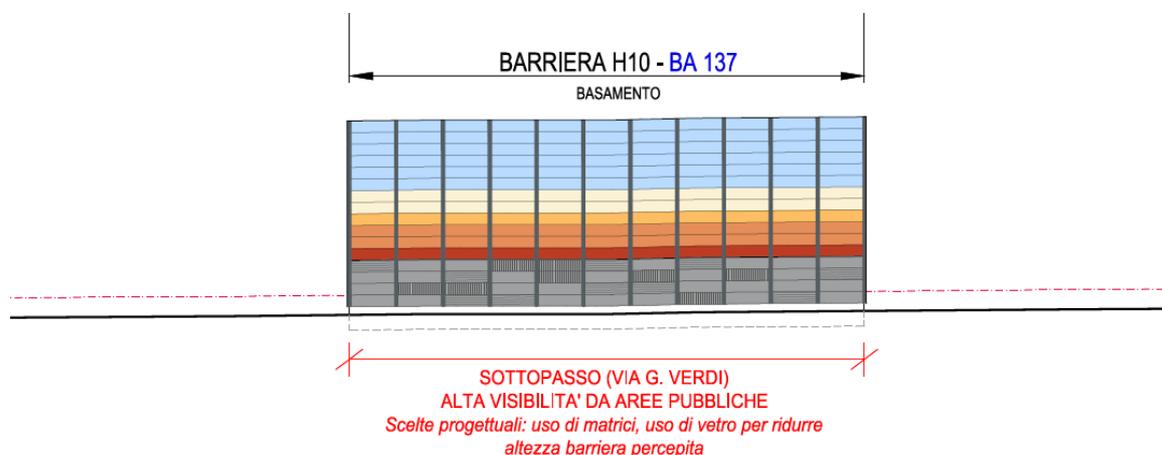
Sviluppo del prospetto BP sottopasso Via Verdi.
